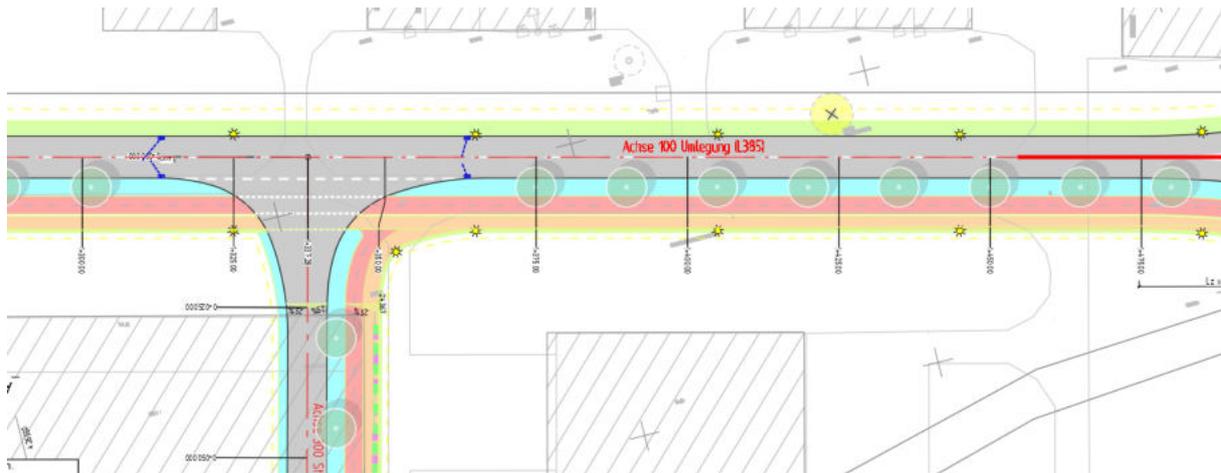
Ausschnitt Lageplan Verkehrsplanung mit Lage der Versickerungsmulden,
